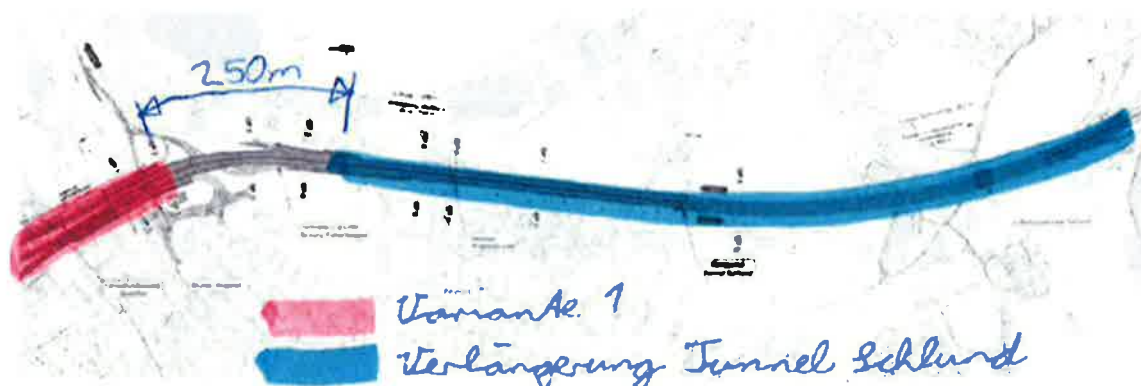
Variante 1 plus Verlängerung Tunnel Schlund
